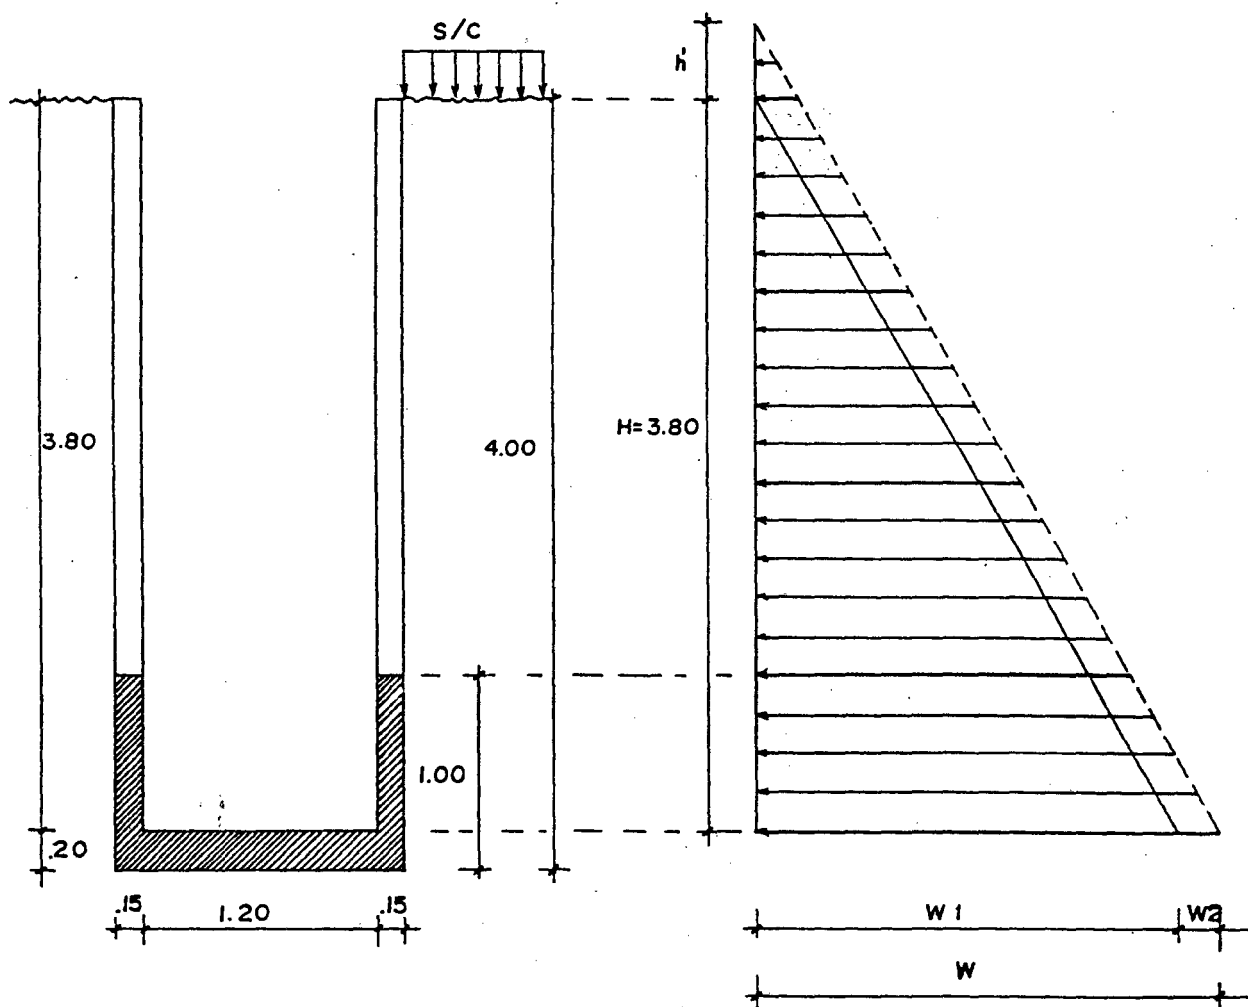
FUERZA DISTRIBUIDA EN LAS PAREDES DE LOS BUZONES
